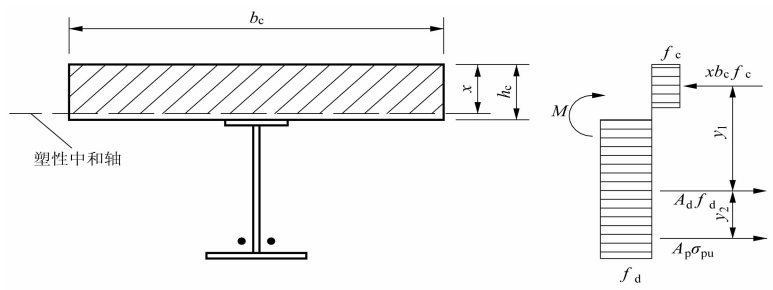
塑性中和轴在混凝土板内时的组合梁截面及应力图形
